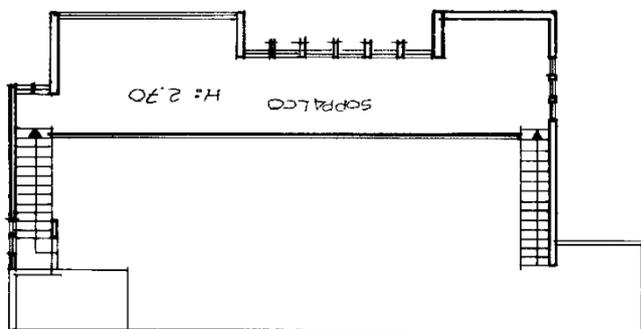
Estratto della planimetria catastale – piano soppalco
